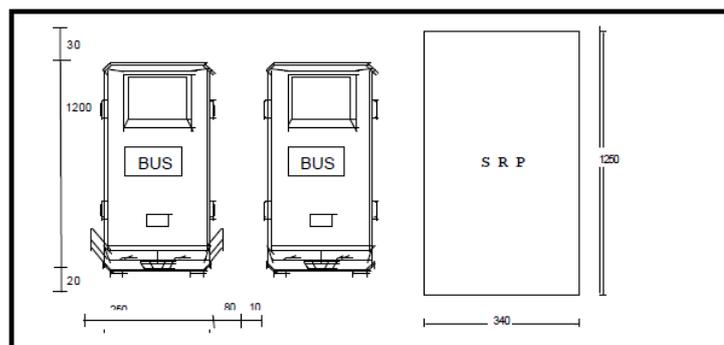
Satuan ruang parkir untuk mobil penumpang (dalam cm)
